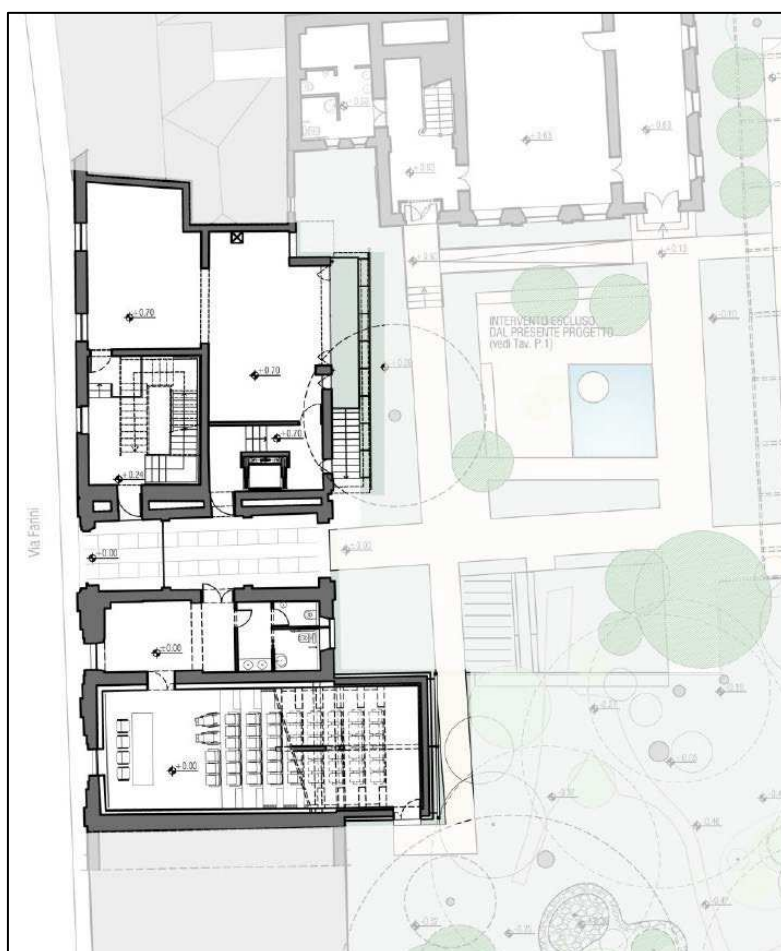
Planimetria progetto di fattibilità dell'Aula Ferrante
